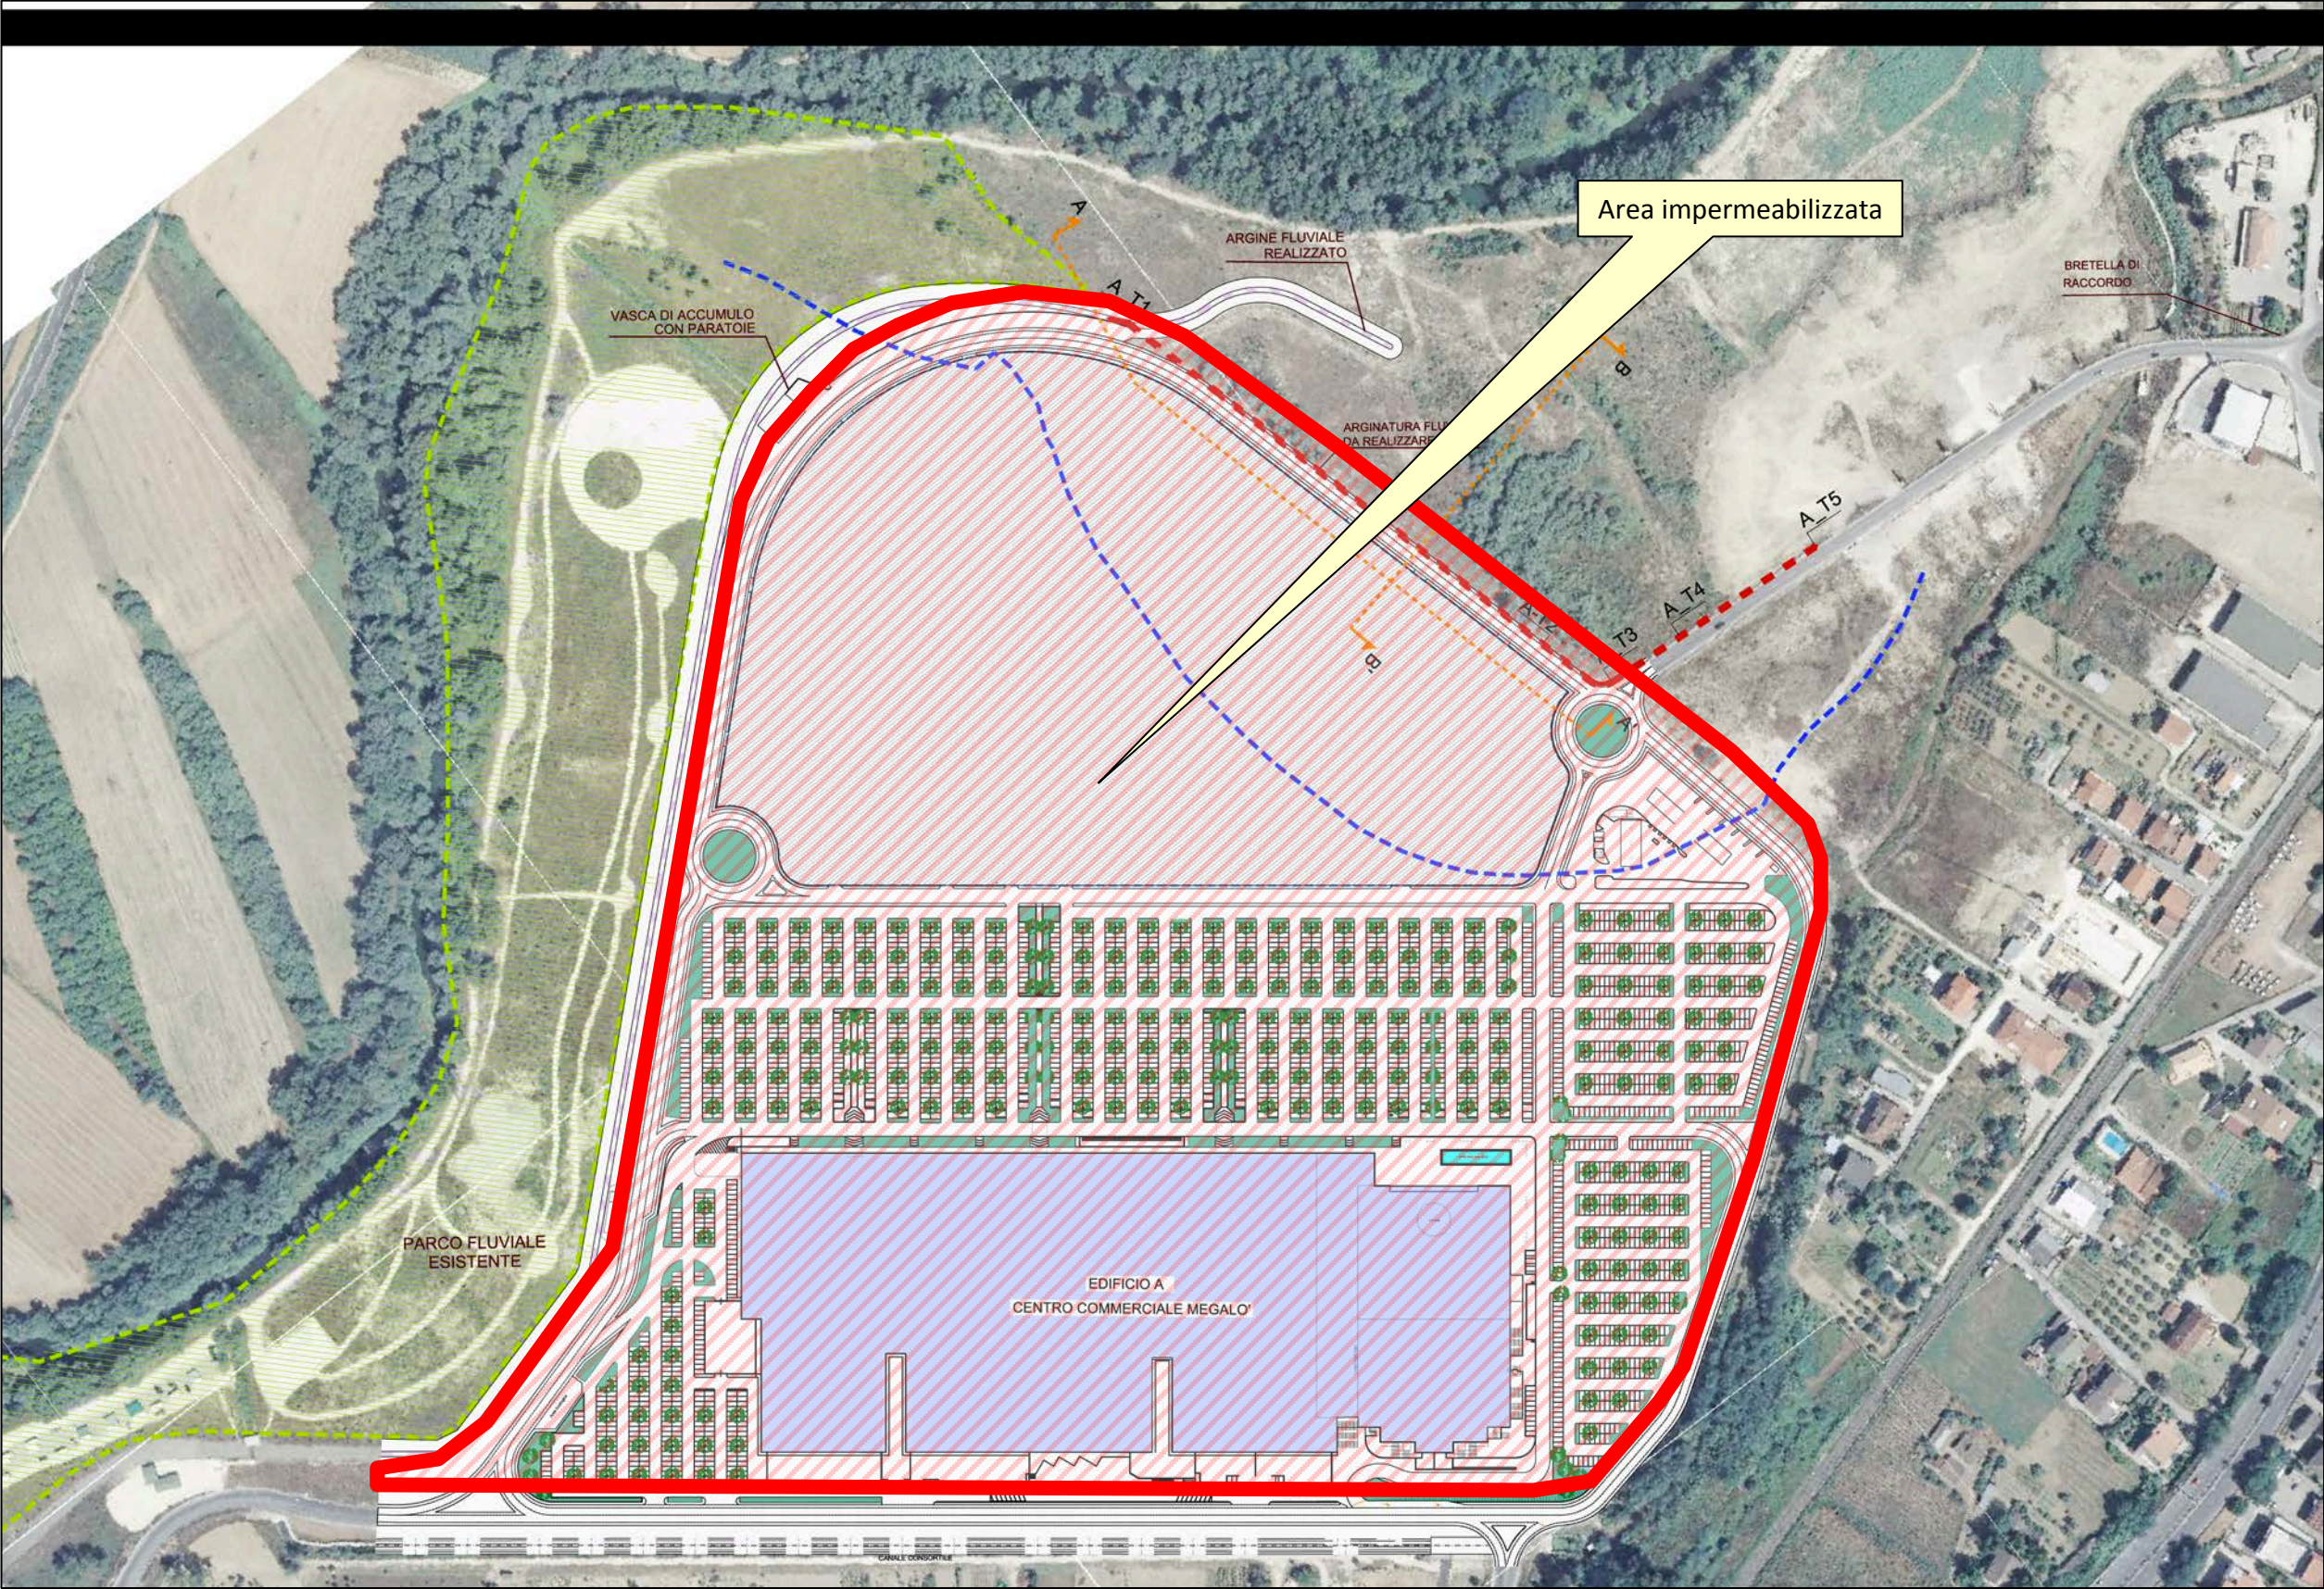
Planimetria dell'uso del suolo dell'area di intervento
